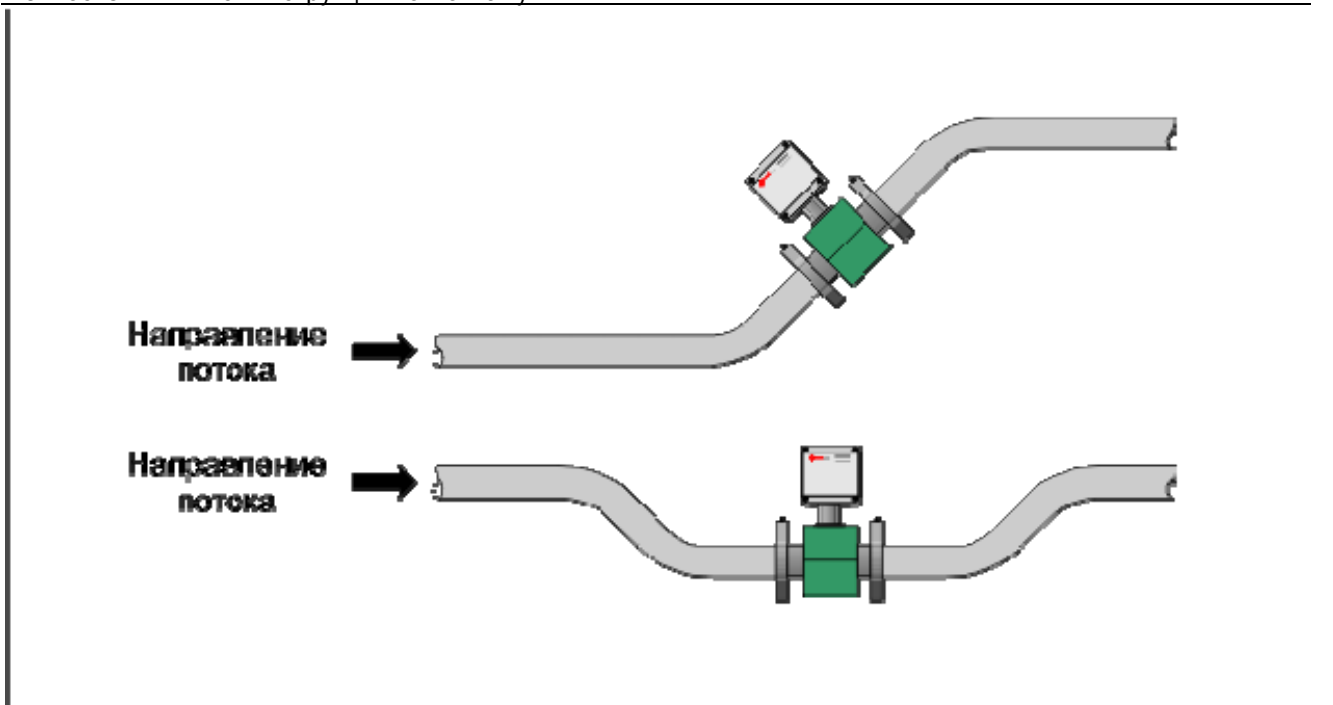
Рекомендованное размещение ППС на горизонтальном трубопроводе
